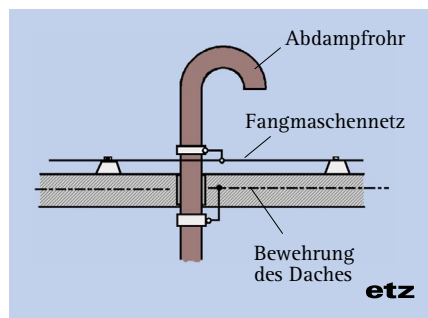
Abdampfrohr als Teil einer Fangeinrichtung, verbunden mit der Bewehrung (Gebäudeschirmung)
